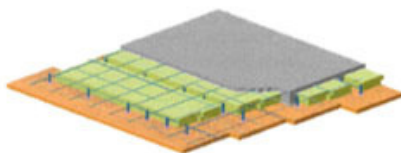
Schema assometrico di solaio Wood Beton Evoluzione.
